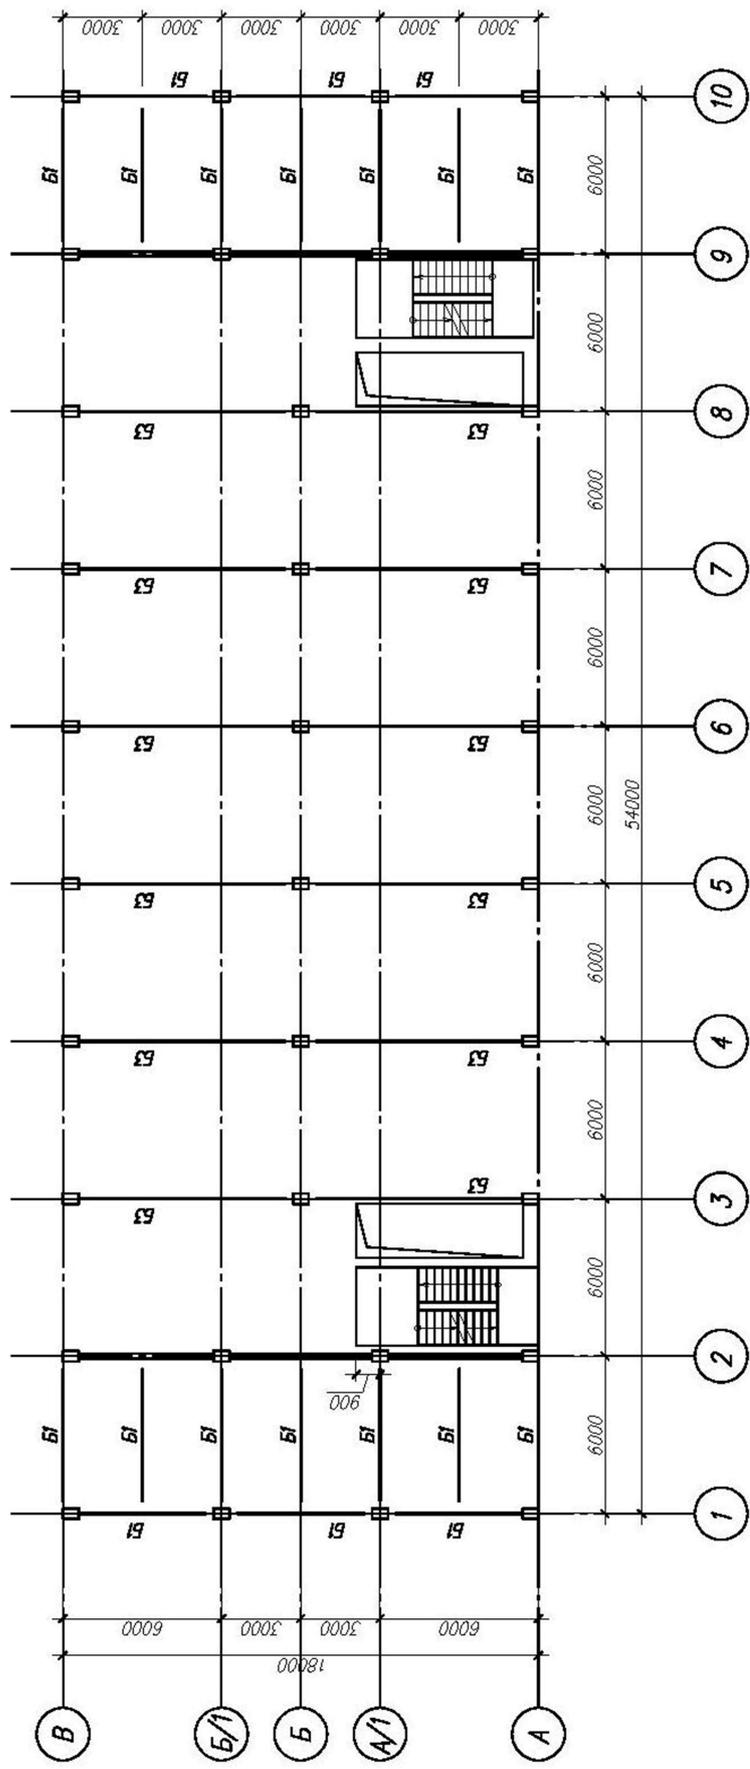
План типового поверху промислової будівлі до реконструкції
